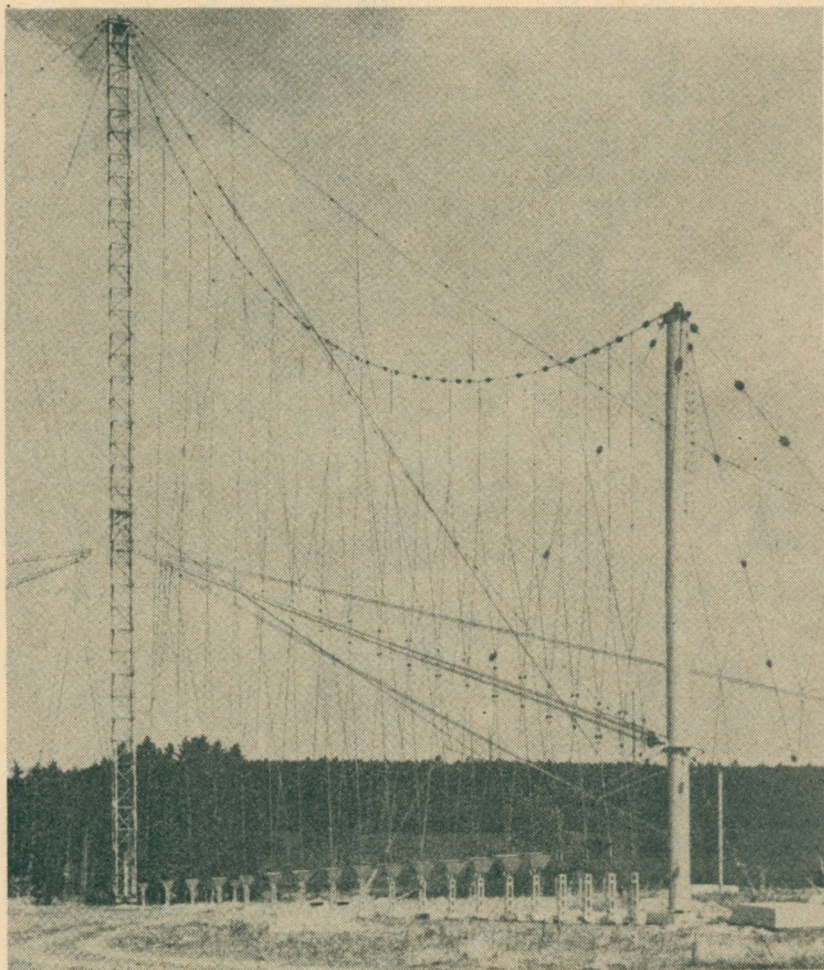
Wieża kratowa jako konstrukcja wsporcza anteny krótkofalowej
